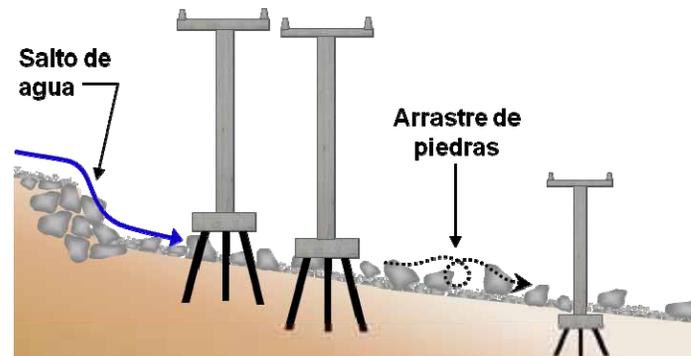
Piedras utilizadas para control de atrincheramiento fueron arrastradas por el río.
